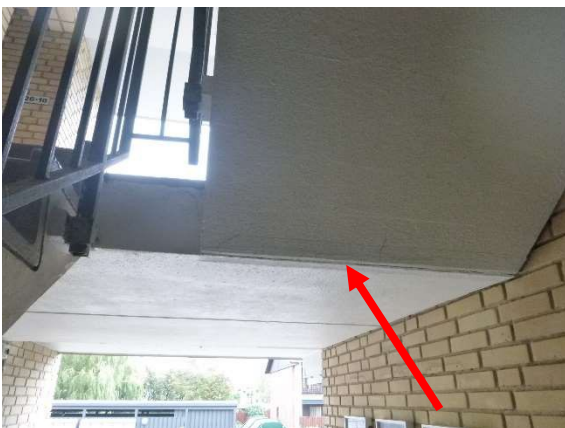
Trappeløb revner på undersiden ved overgang til altangangselementet. (Punkt 11)
